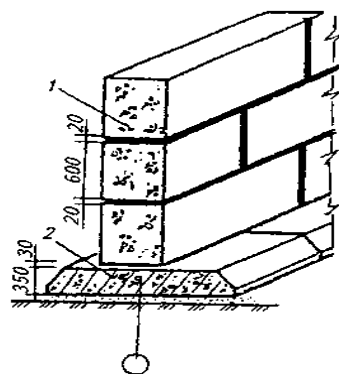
Ленточные фундаменты: 1 – стеновые бетонные блоки; 2 – фундаментная железобетонная плита
